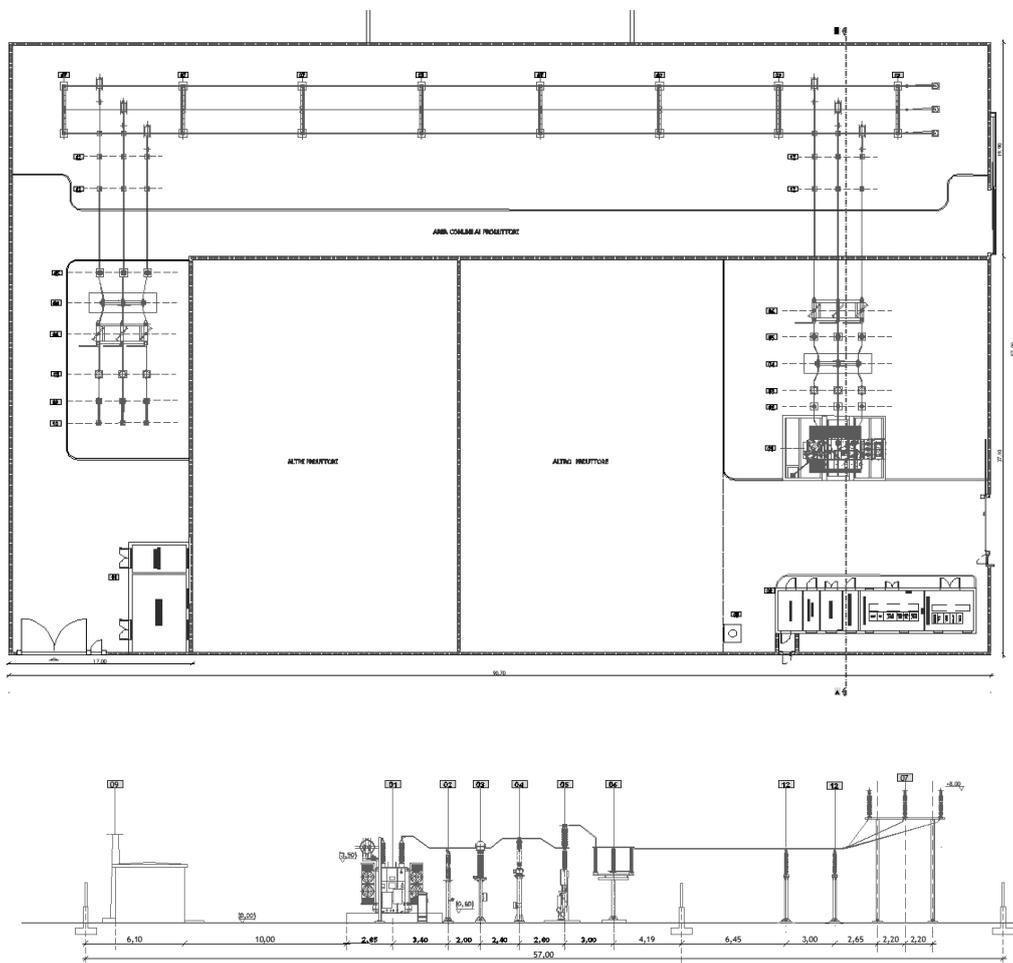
Planimetria elettromeccanica della Stazione Elettrica di Utente
